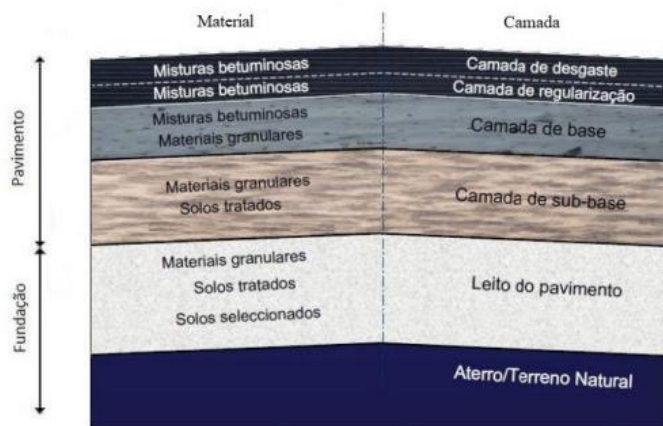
Seção transversal de um pavimento flexível (Kolodi, 2023).
